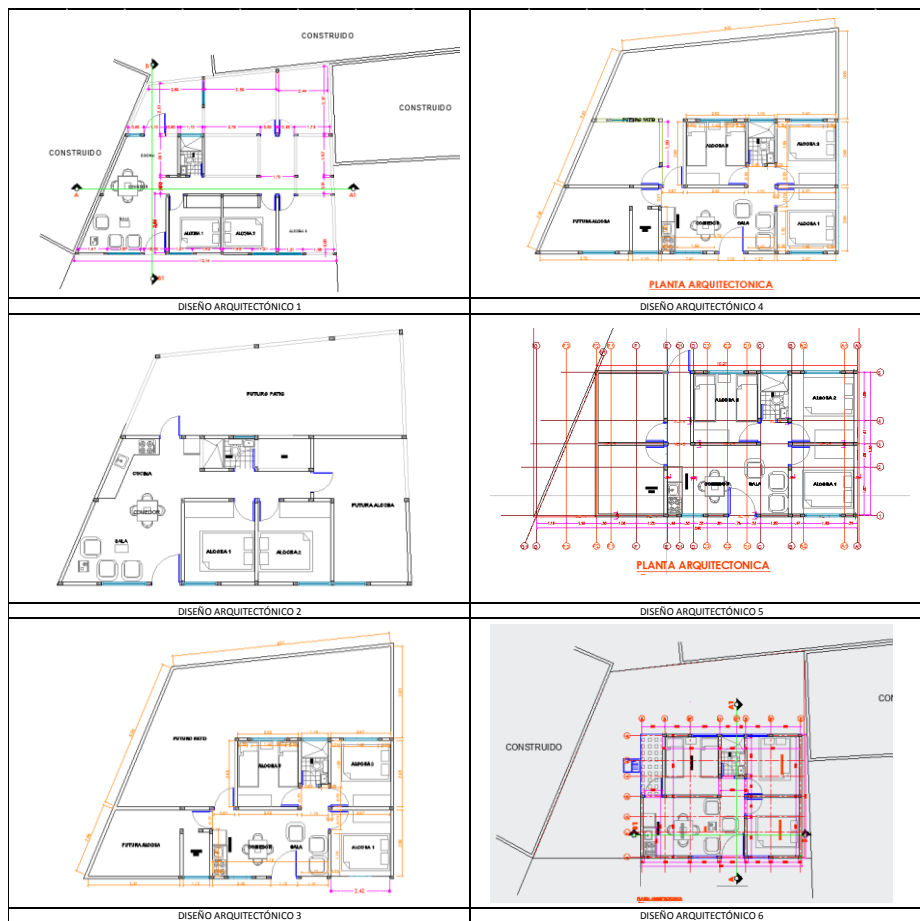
Diseños Planta Arquitectónica Sra. Yolanda Gil
